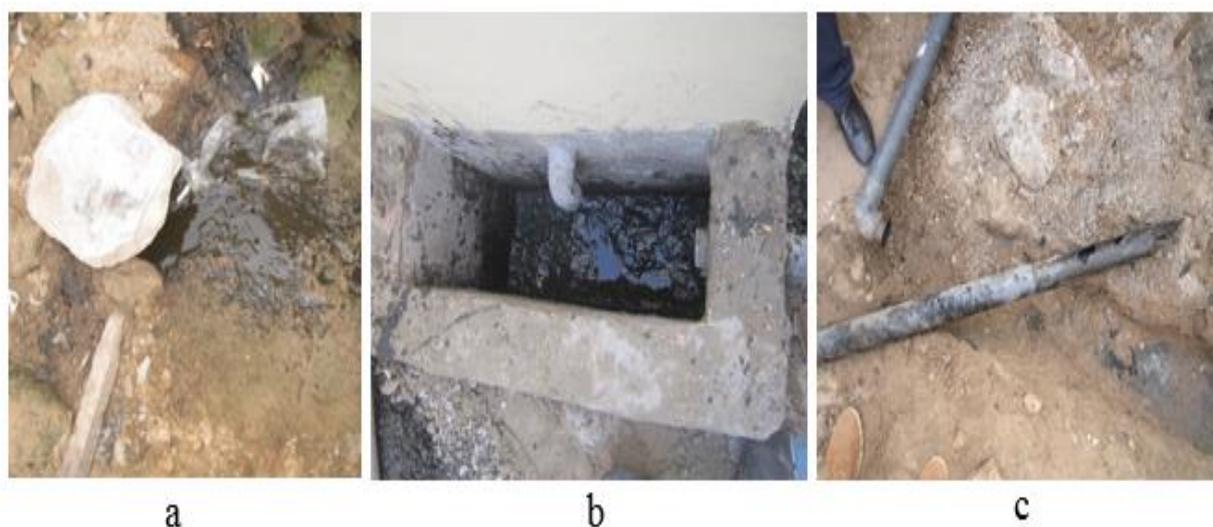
Affleurement des eaux sortant du drain (a); Conduite d'entrée et de sortie du filtre au même niveau (b); Conduite drain défectueux (c)
